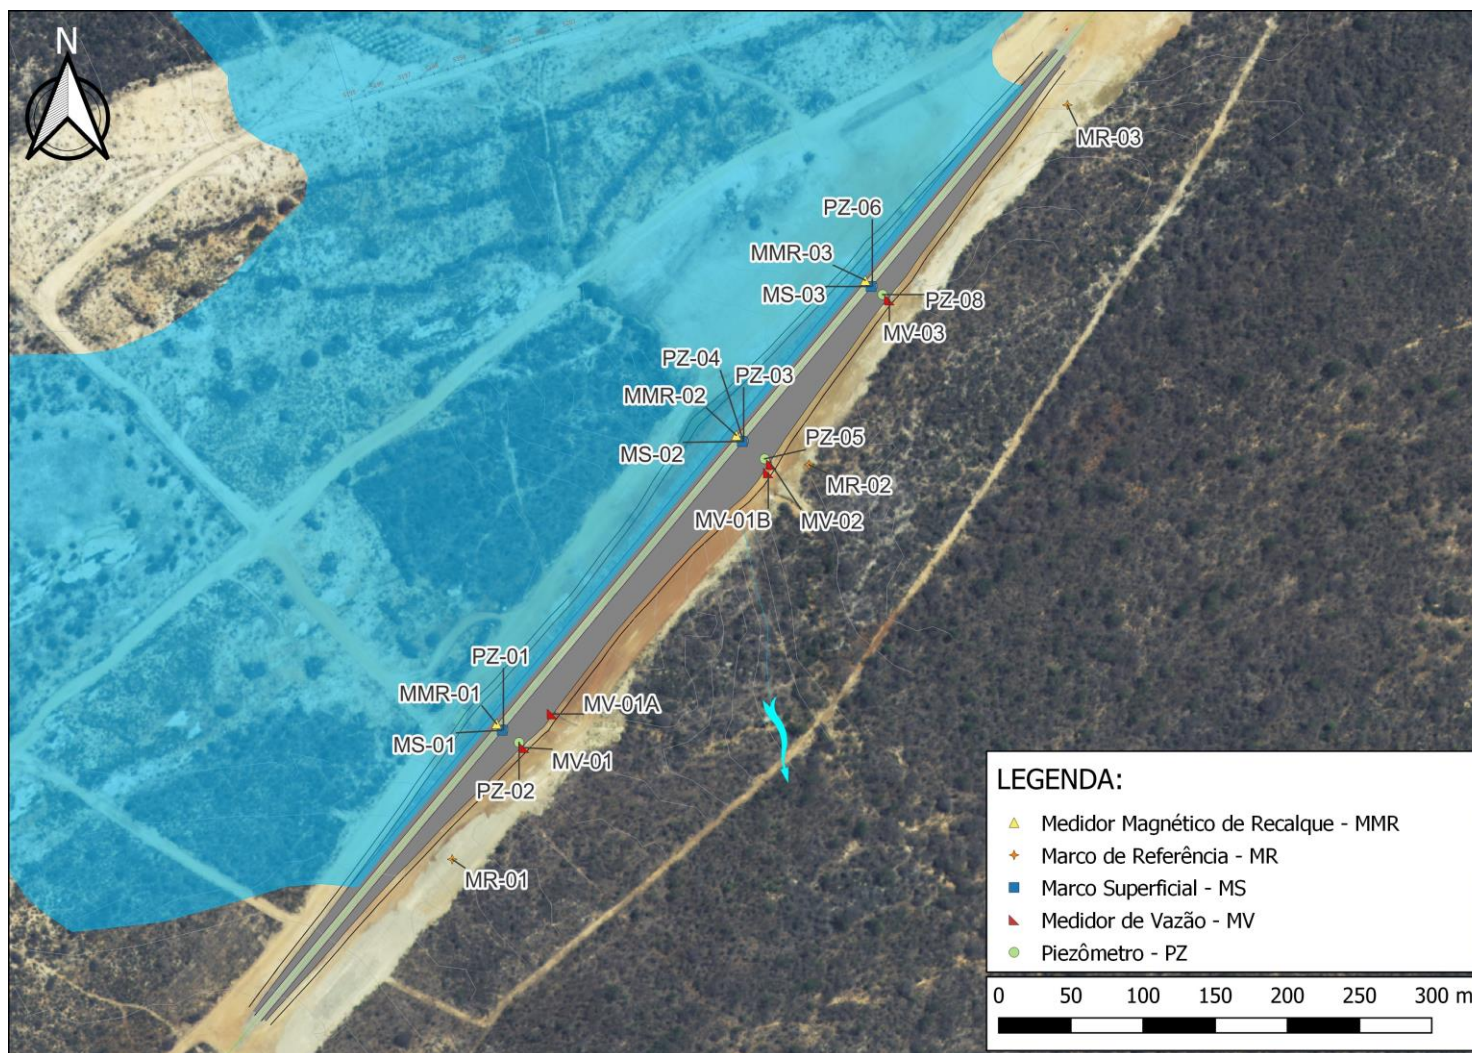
Planta de localização da Instrumentação do Dique Bagres. Fonte: Projeto Executivo n.º 1230-DEP-2110-20-04-001-R04 modificado/Google Satélite DATUM SAD 69.
